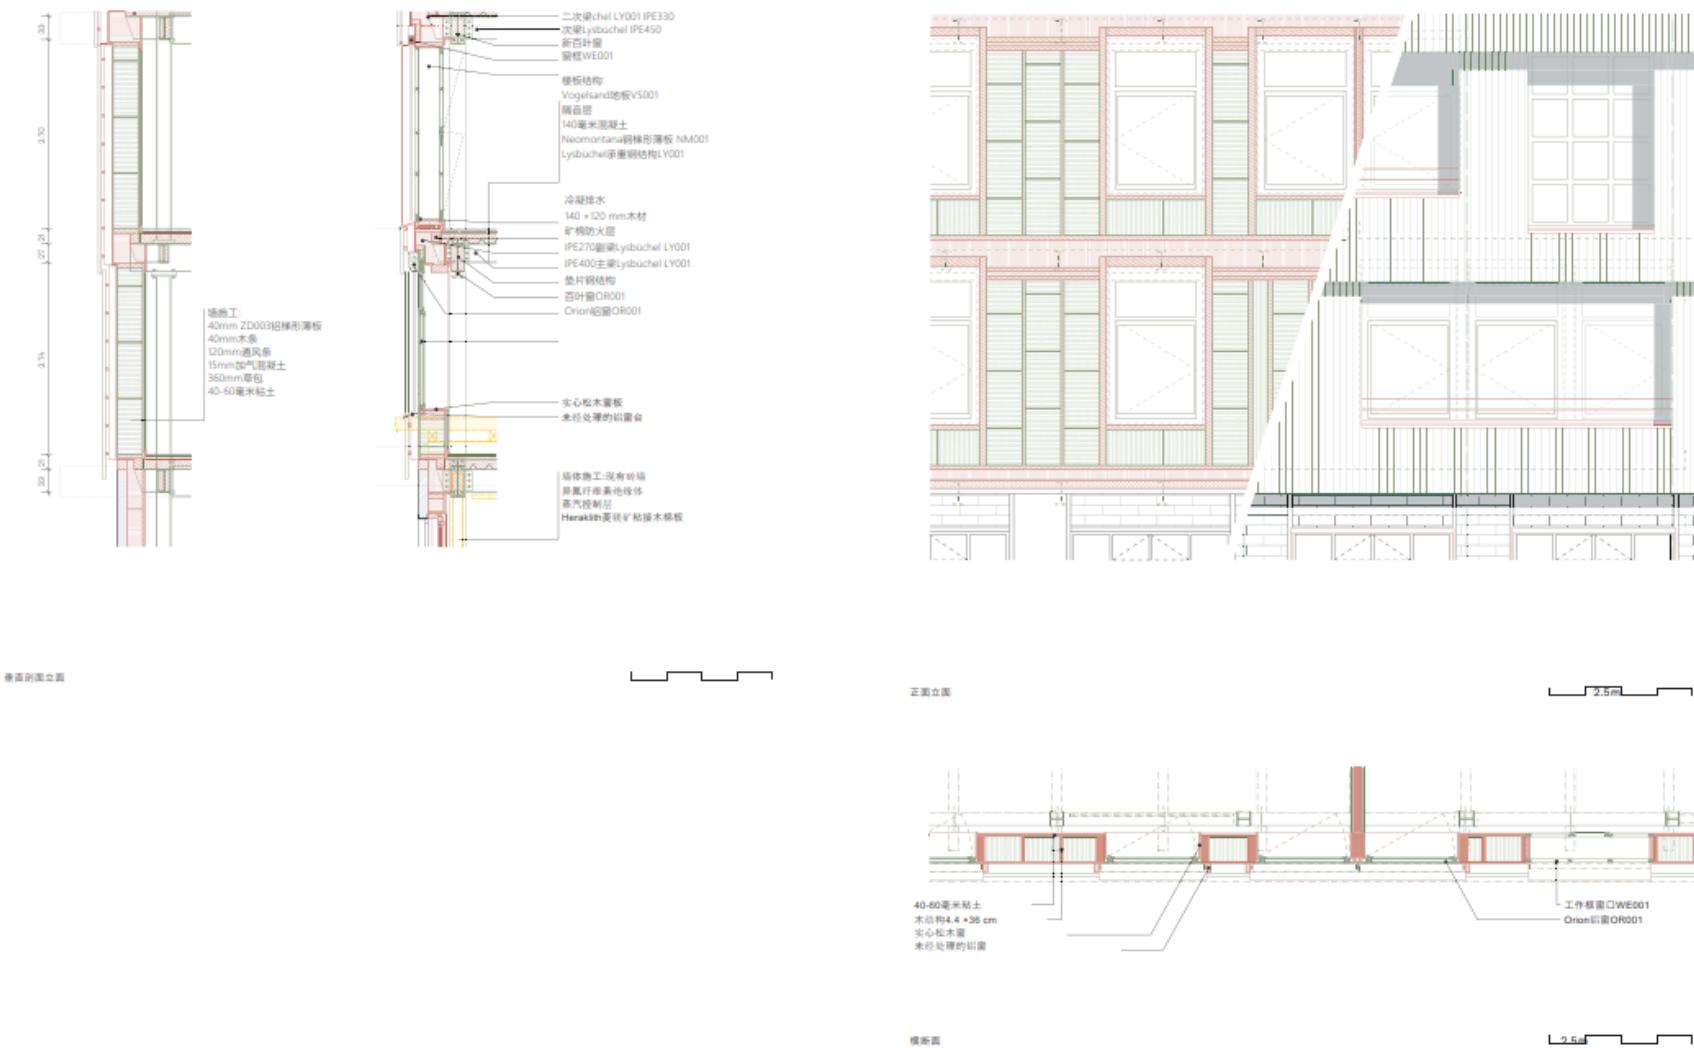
外立面详图 (包括剖面图和平面图) ©Baubüro *in situ
